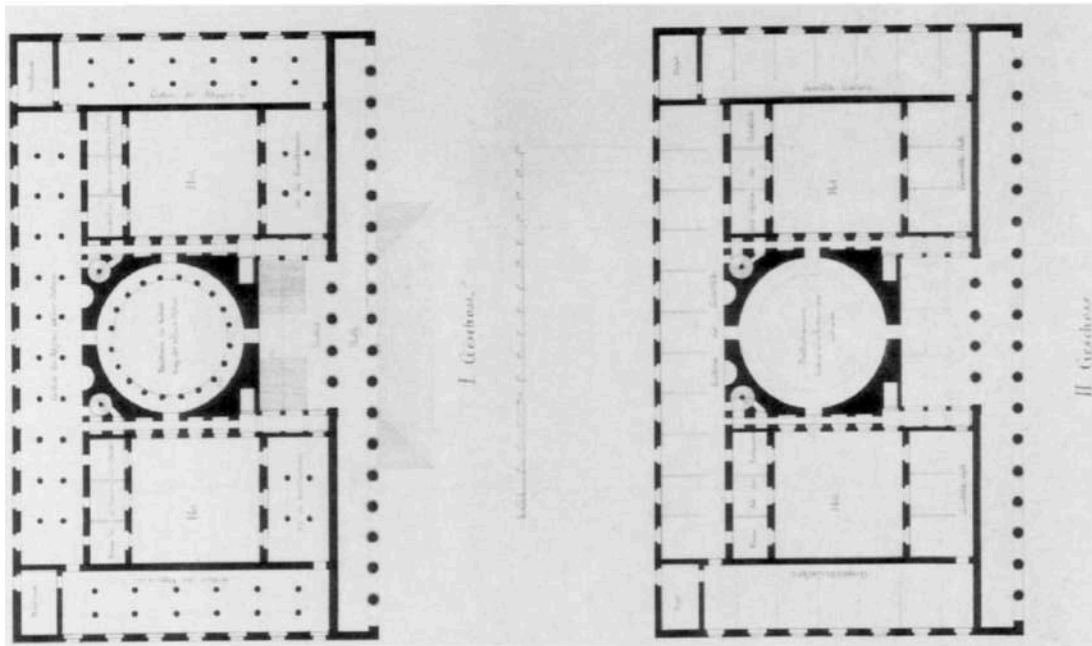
Prime proposte di pianta, Altes Museum, F. Schinkel, 1823.
